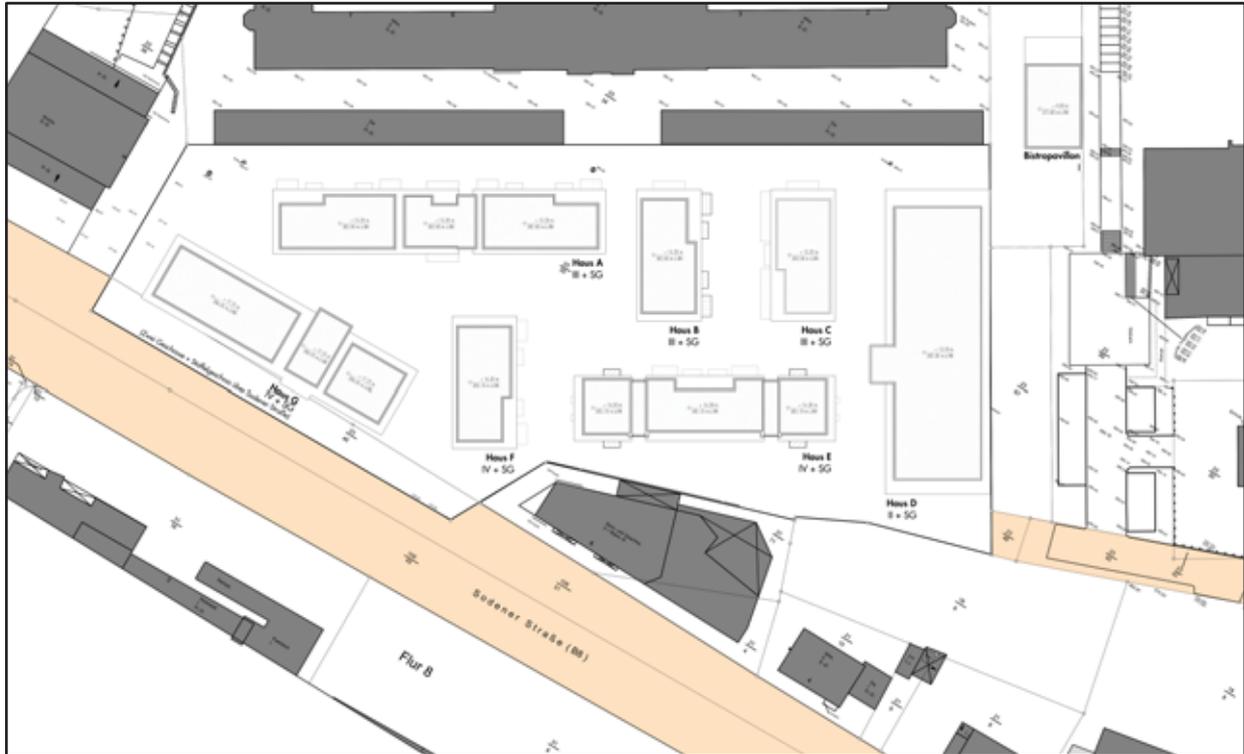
Dachaufsichtsplan aus den Unterlagen [b] mit den geplanten Gebäuden
